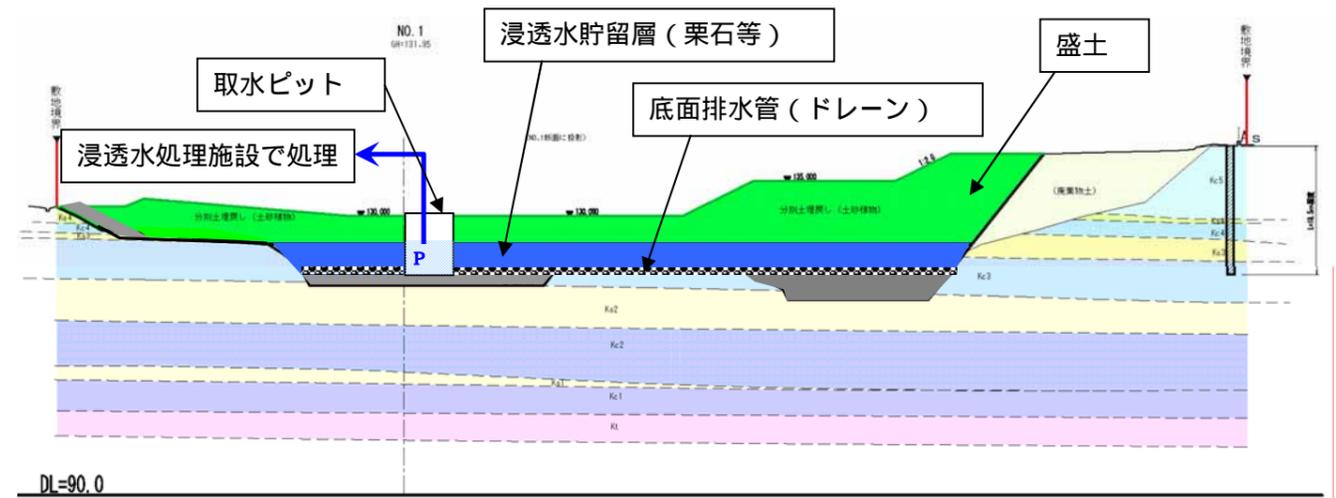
(3) 底面粘性土修復工および側面遮水工の施工方法（浸透水貯留層、盛土の施工）
